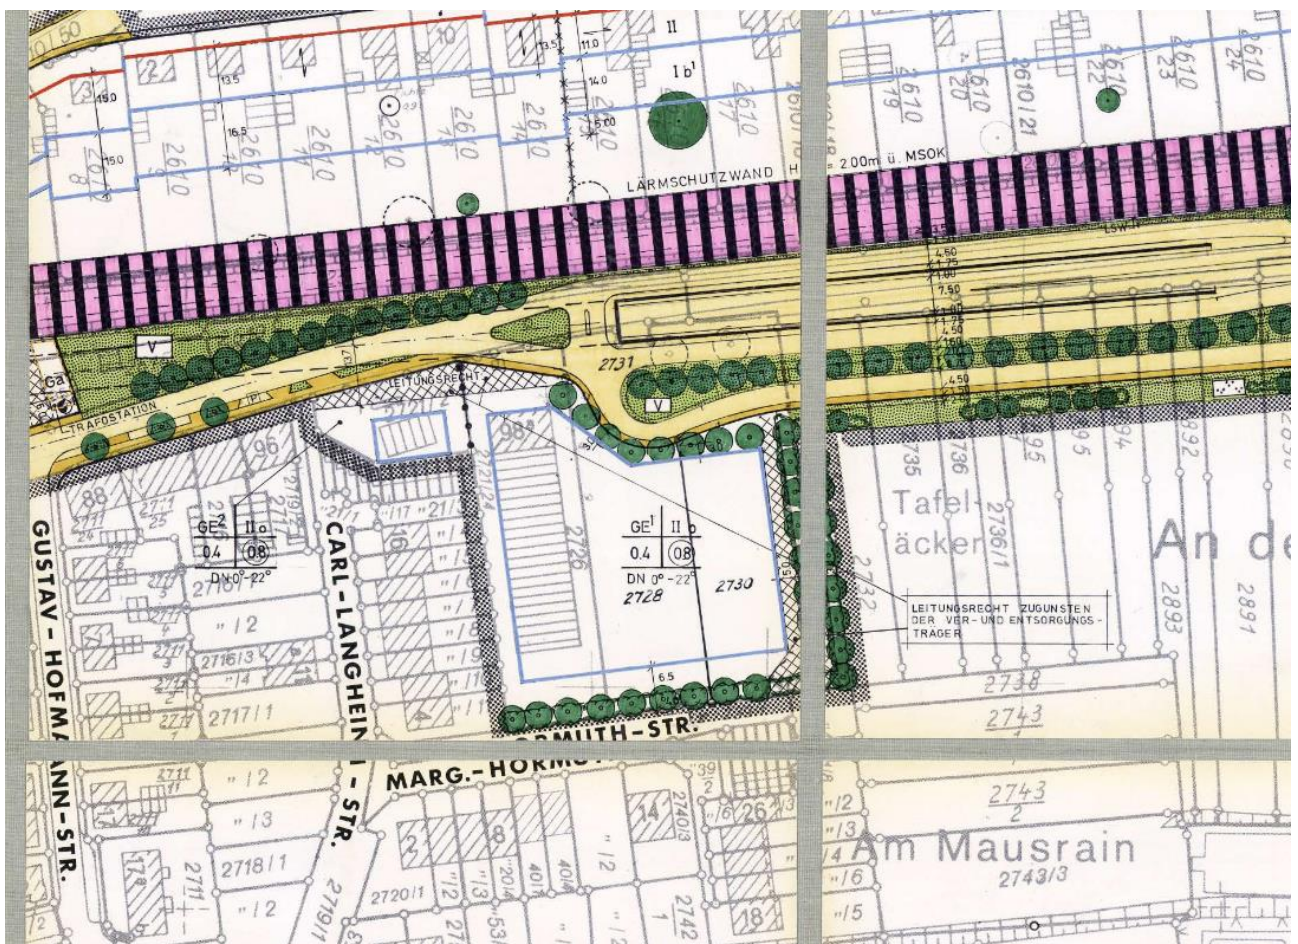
Ausschnitt aus dem Bebauungsplan 694a Augustenburgstraße (Tunnel B 10) Stadtbahn Berghausen, Wiesenäckerweg, Quelle: Bebauungsplan-Auskunft Liegenschaftsamt Stadt Karlsruhe
